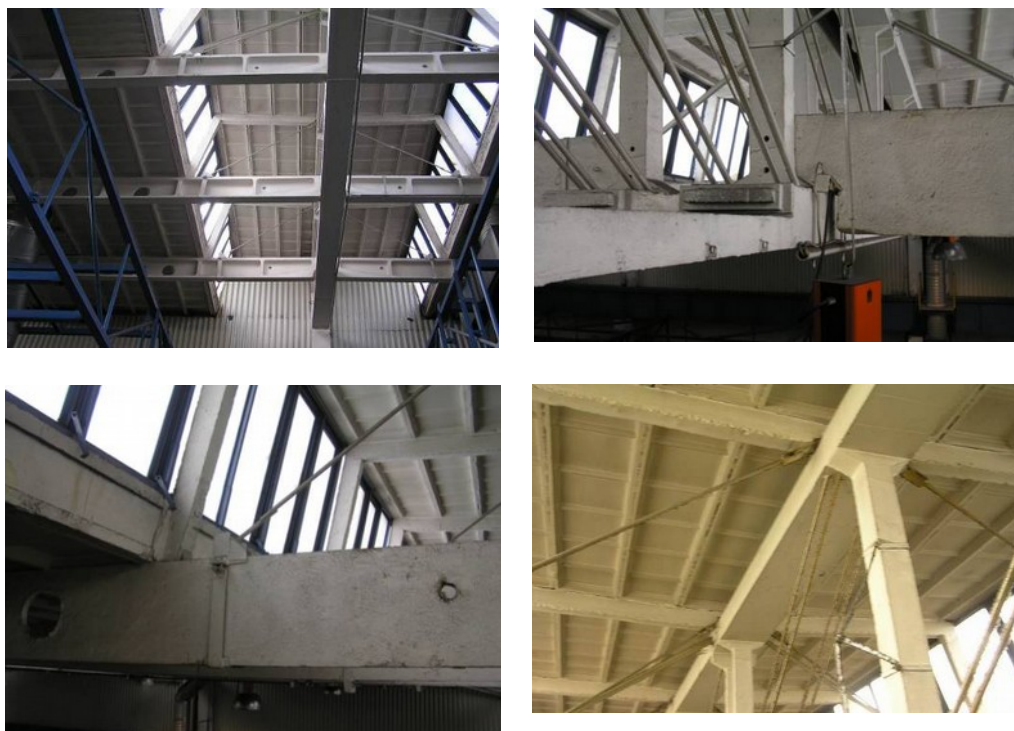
Šestilodní hala, 204 x 144 m (1961- 1963). Železobetonová montovaná konstrukce, osová vzdálenost sloupů 12 x 24 m, výška 15 – 16 m
